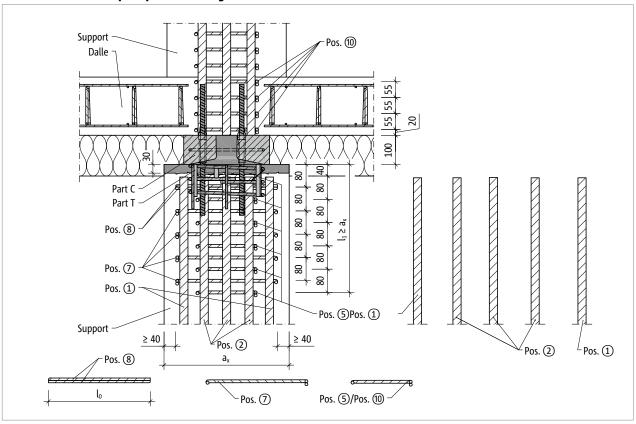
Schöck Sconnex® type P: renforcement sur site dans la coupe longitudinale A-A du poteau
